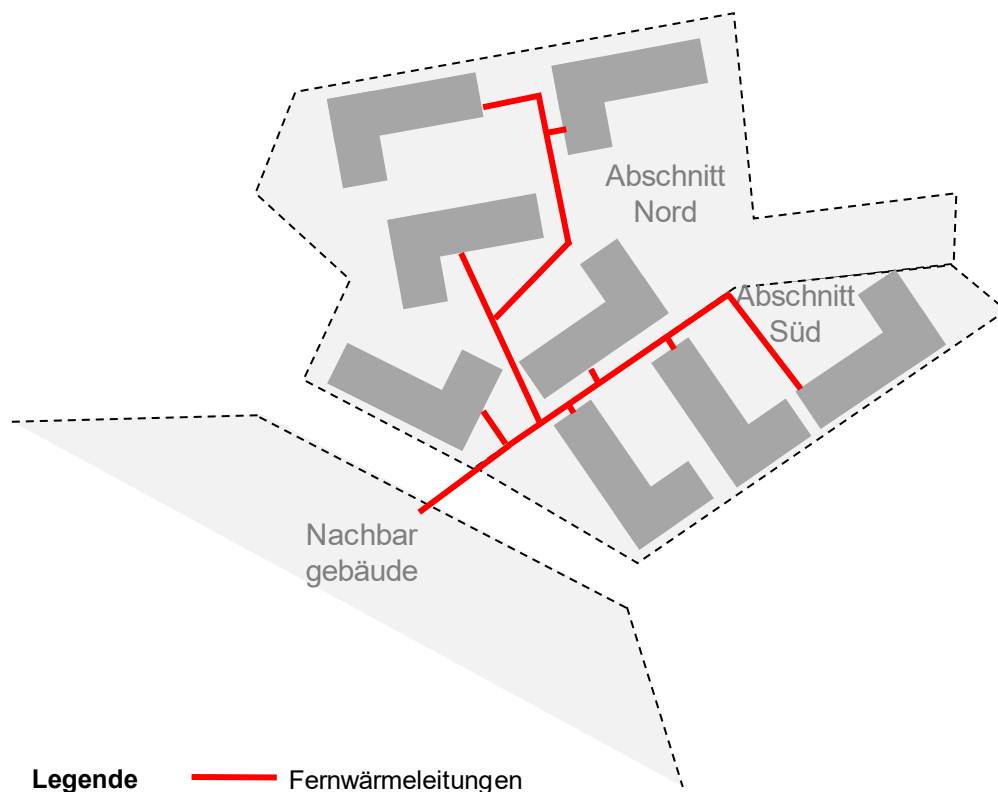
Möglicher Lageplan der Fernwärmeleitungen
